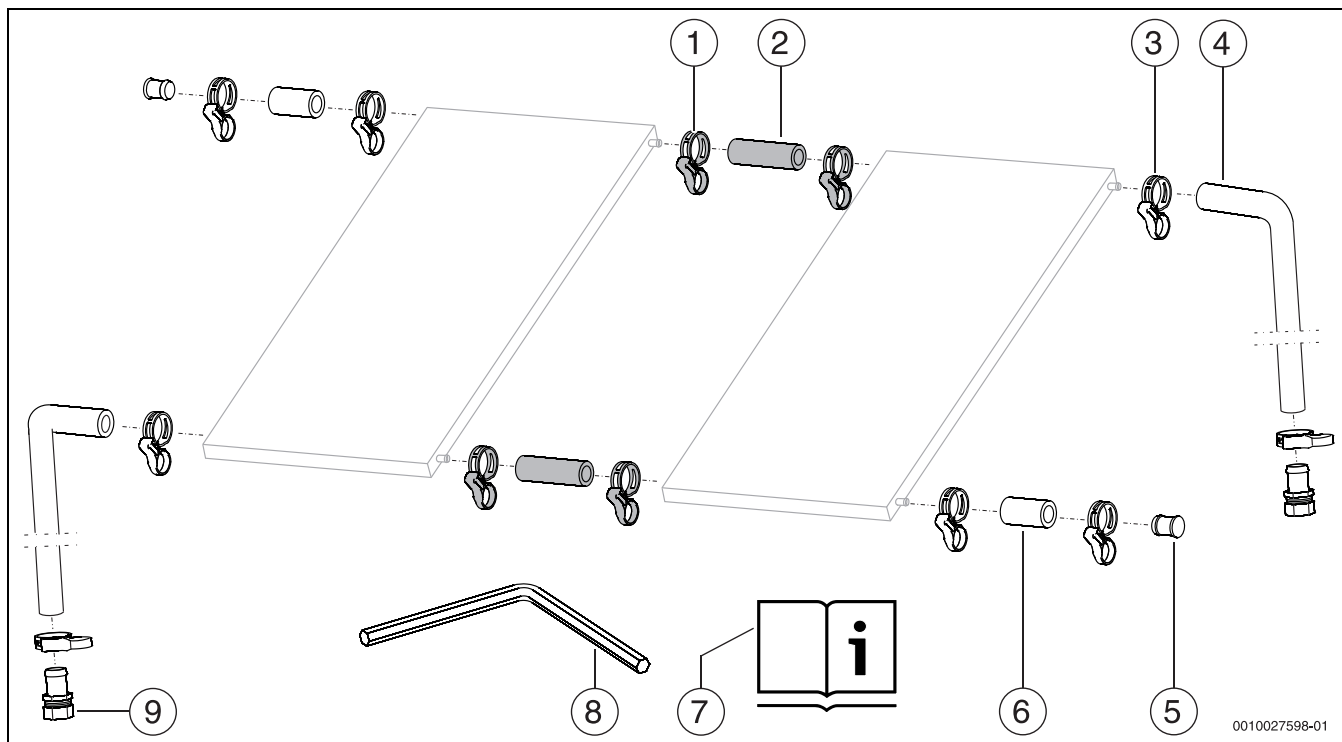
1 kit de raccordement sur le toit et 2 kits de raccordement (gris)
